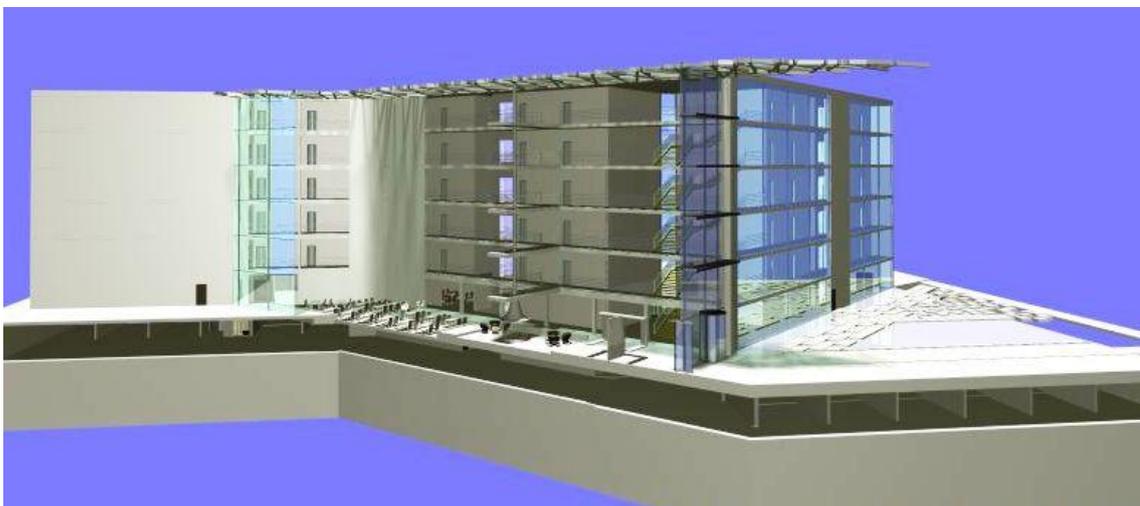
Imagem 3D do hotel/secção CC, sem pilares exteriores
